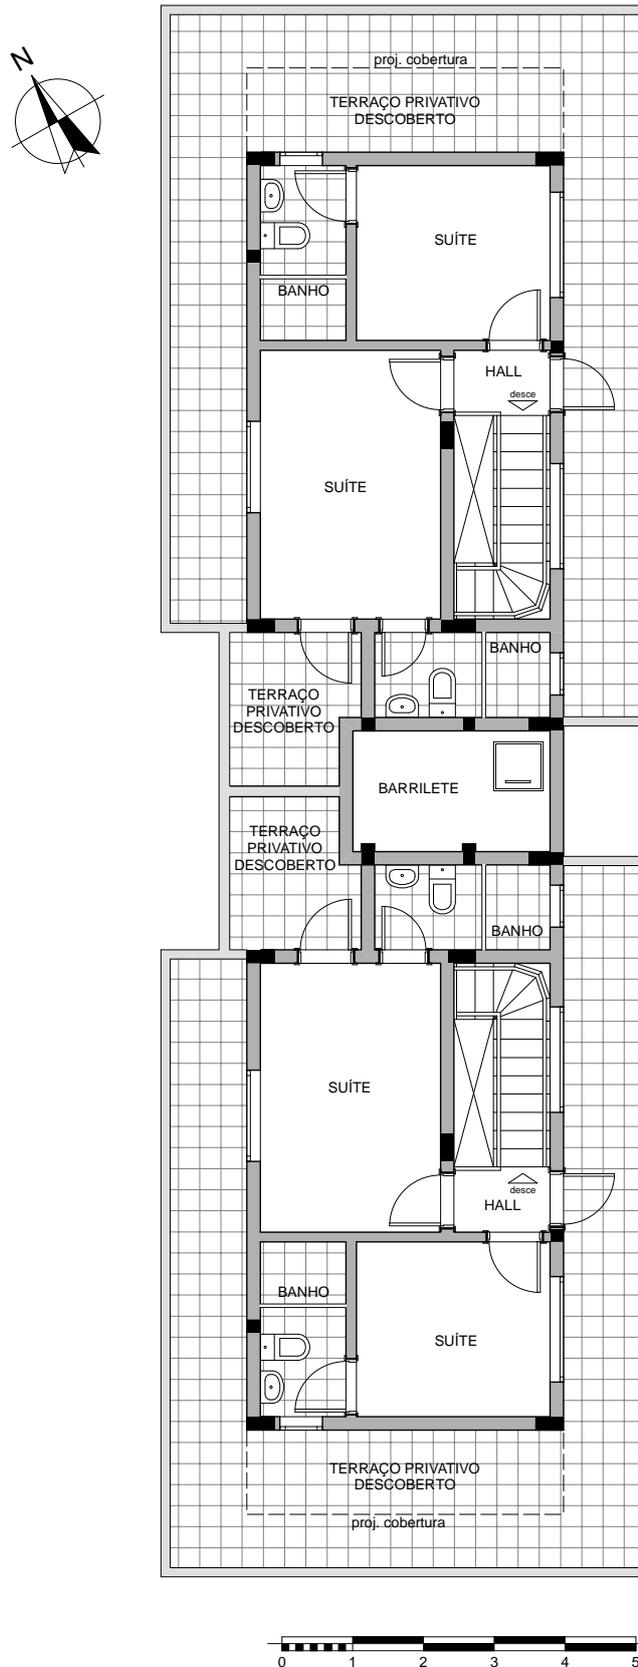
Planta 4º pavimento – cobertura (Fonte: Autora, 2016)
